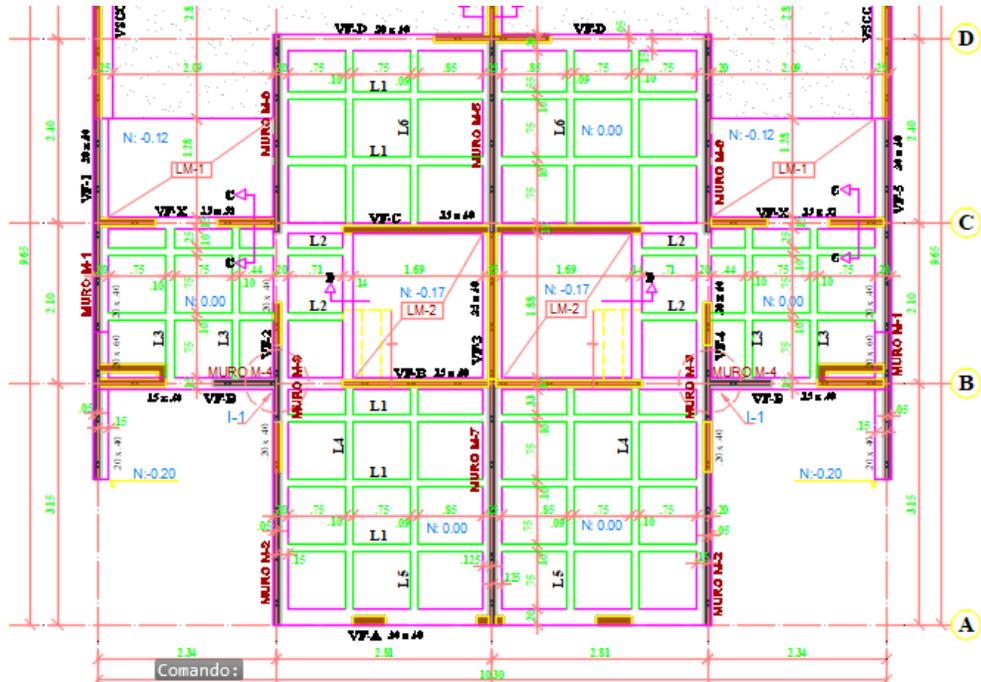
Planta Losa de Cimentación del proyecto Villas del Duruelo.
